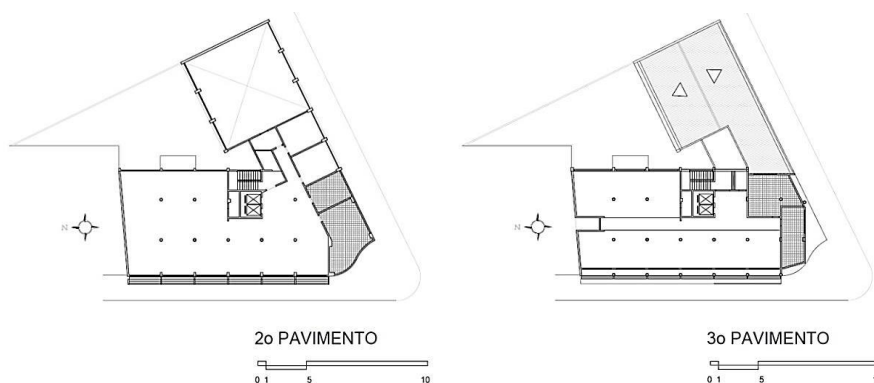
Planta do 2º Pavimento do Centro de Exportadores, retirada do projeto original.
